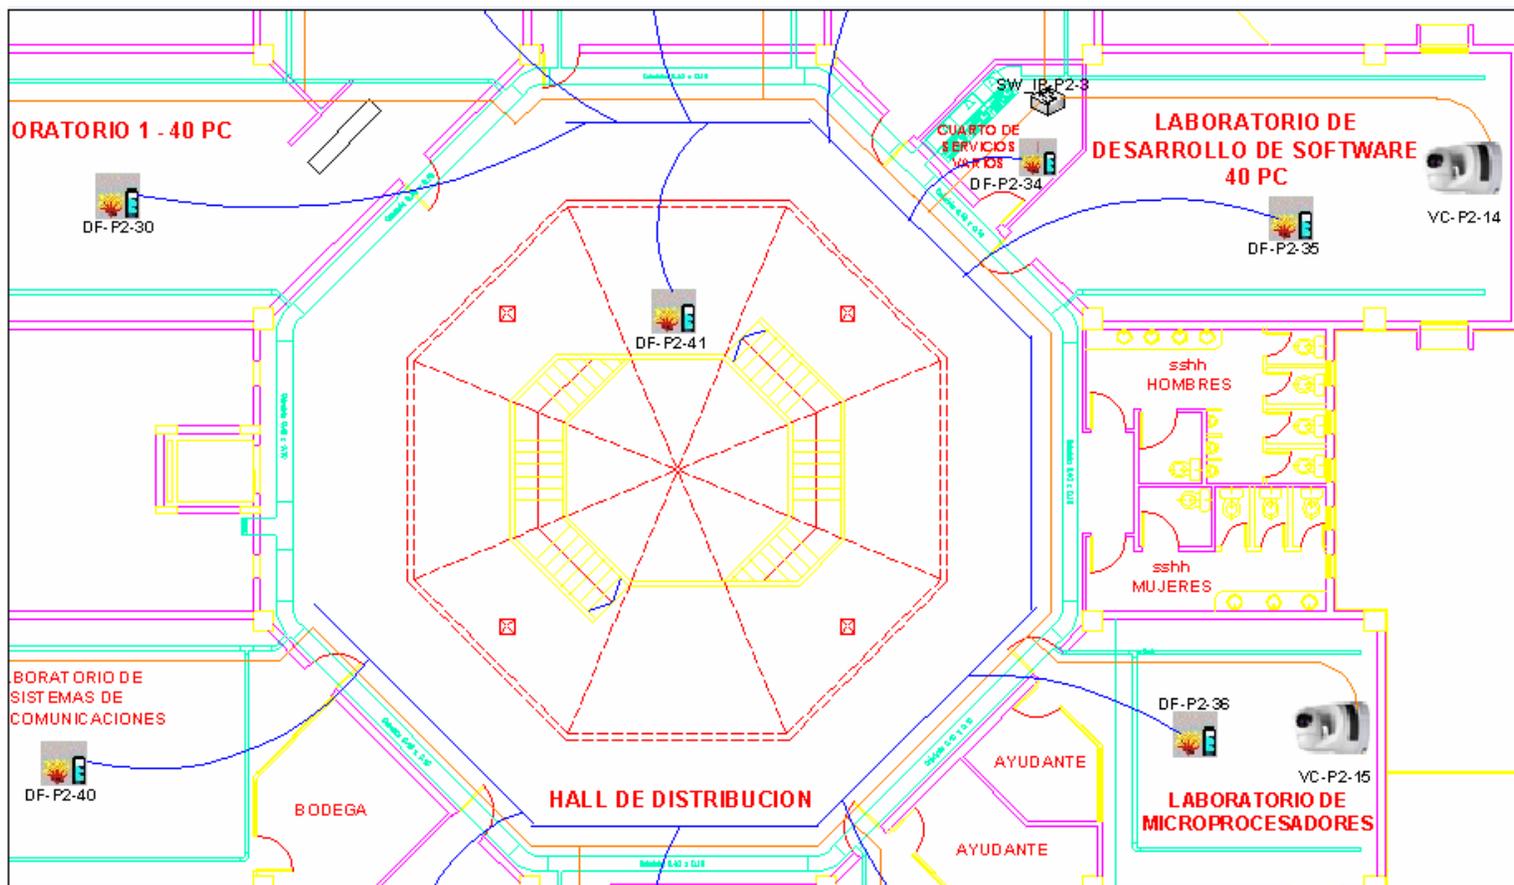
PLANO SEGURIDAD SEGUNDO PISO SECCION 2
